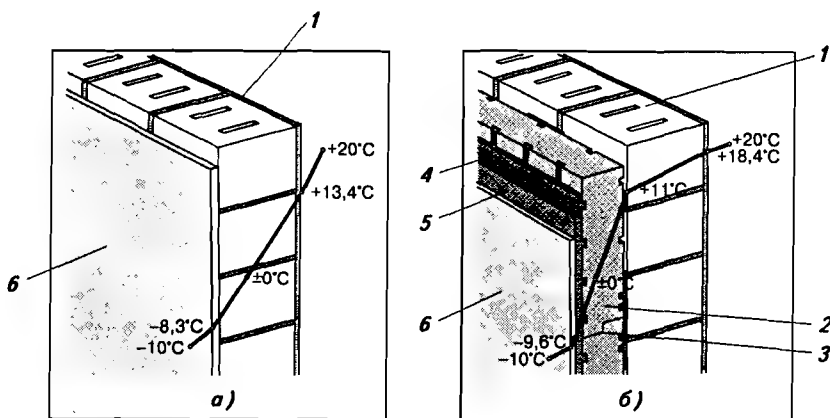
Теплоизоляция наружных стен существующих зданий
